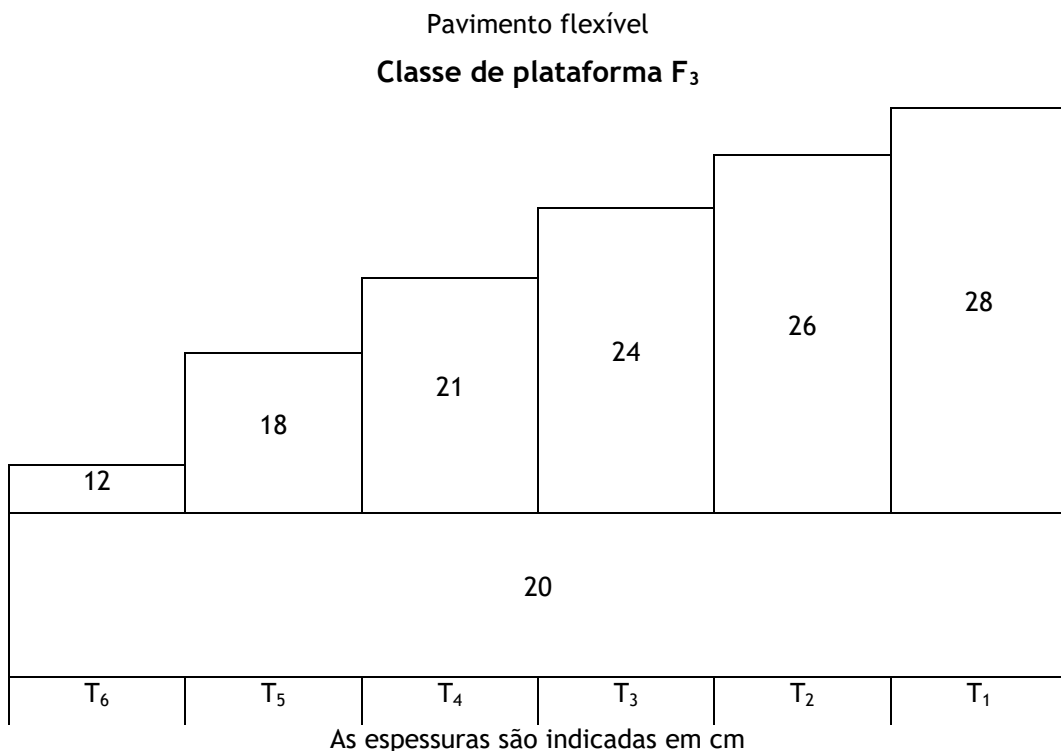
Pavimento flexível de base betuminosa: estruturas indicadas pelo MADIPAV
